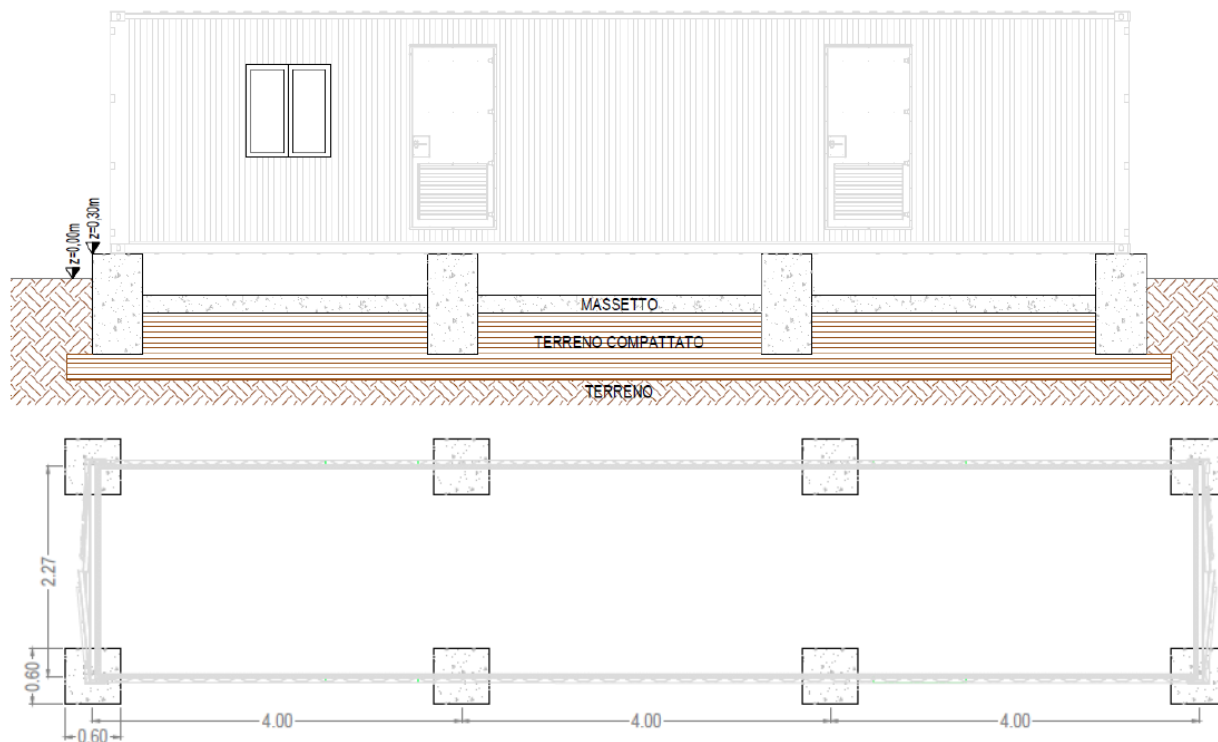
Pianta e sezione della cabina di trasformazione MT
